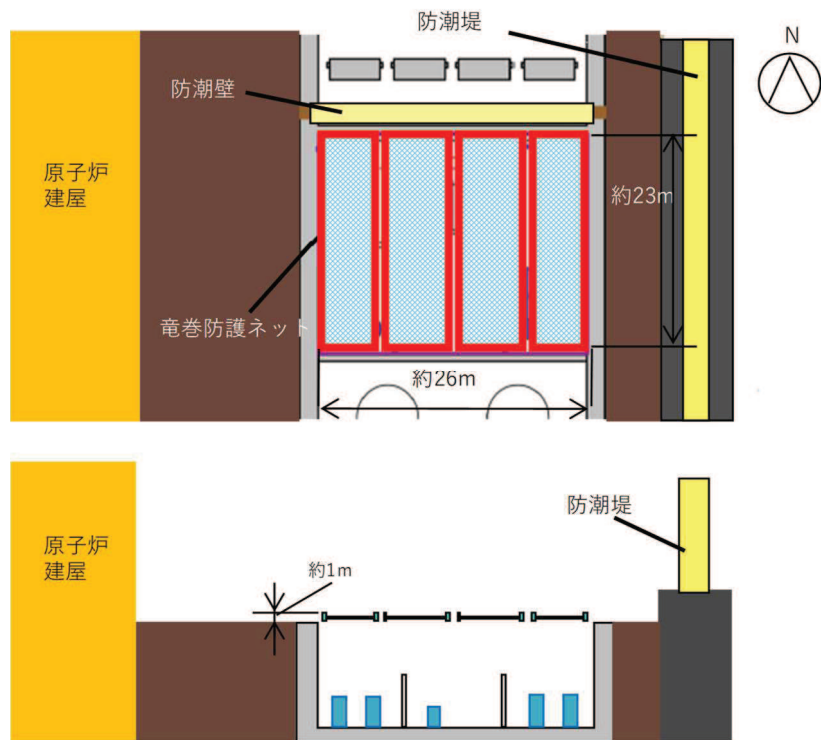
竜巻防護ネットの配置図 (平面図・俯瞰図)
